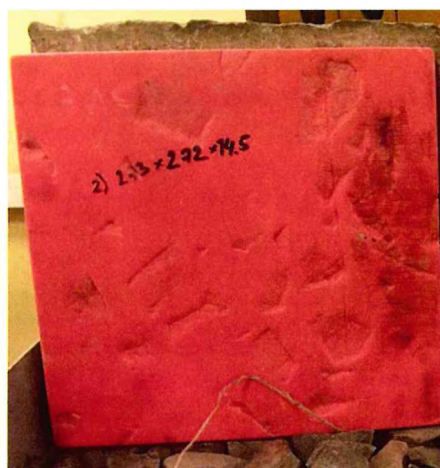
Образец мягкой подшпальной прокладки после 2 млн циклов испытательной нагрузки
